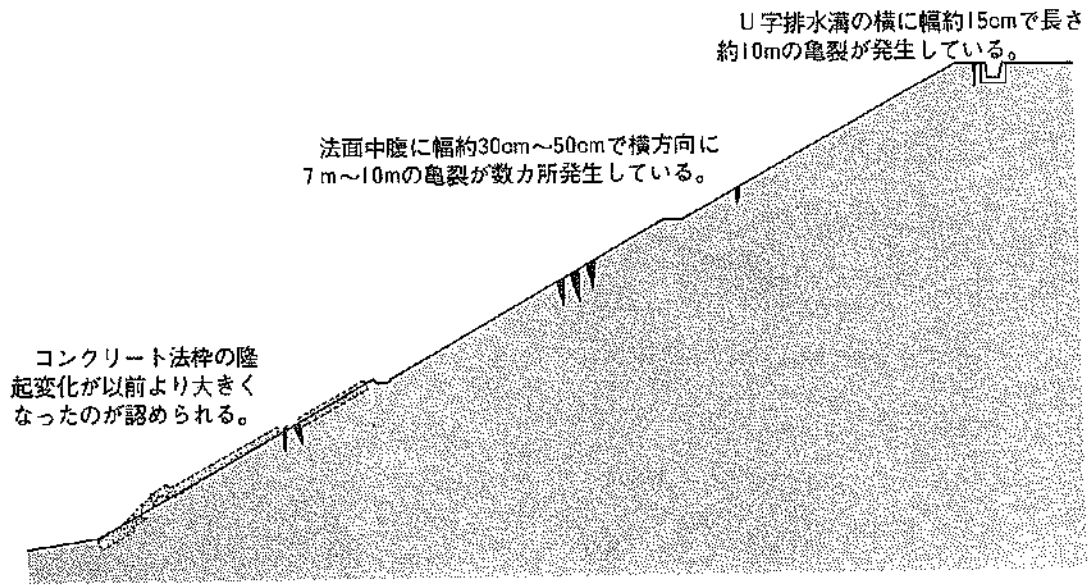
釧路空港南東側の盛土被災状況断面図 (A-A断面)
